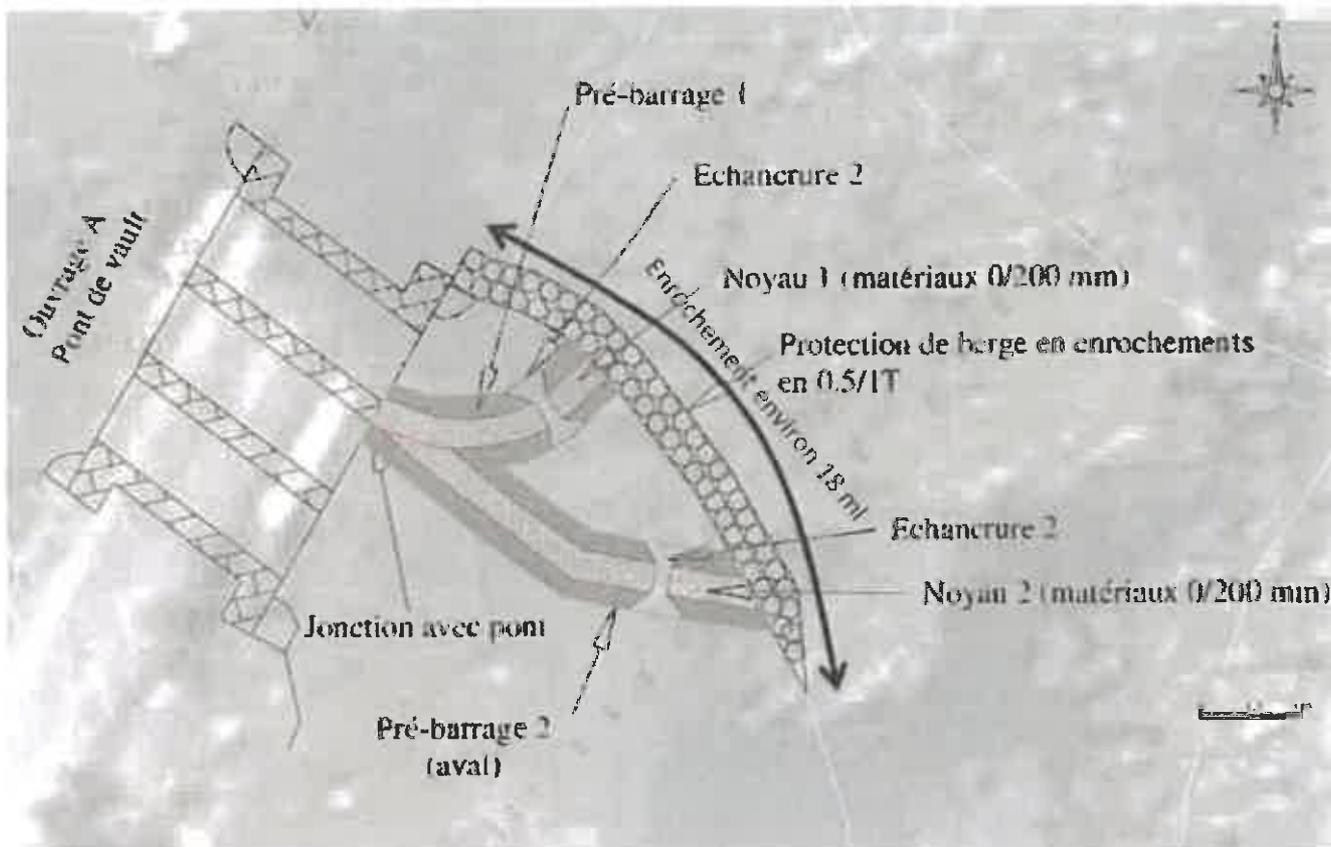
Schéma d'implantation des prébarrages en aval RG du pont
